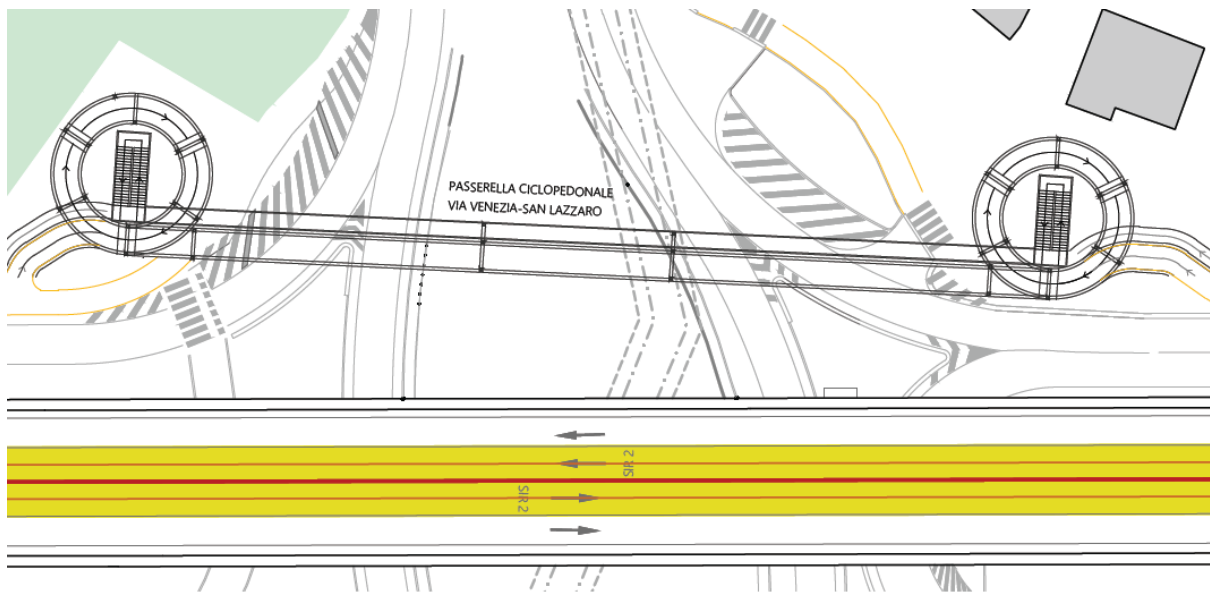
Passerella ciclopedonale Via Venezia -San Lazzaro_Pianta
